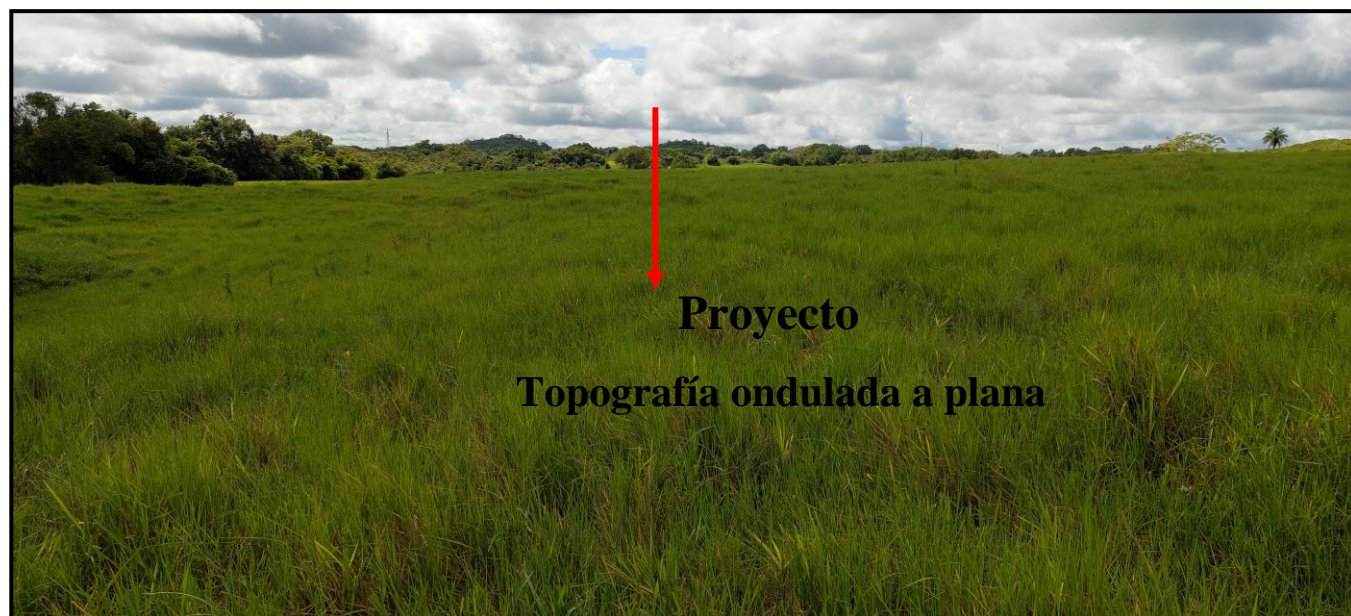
Topografía del Terreno del Proyecto; Ondulado Plano
